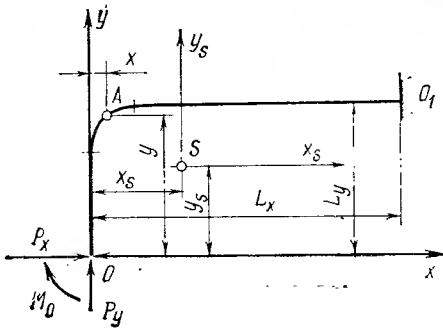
Схема плоского неразветвленного паропровода к расчету на самокомпенсацию.
